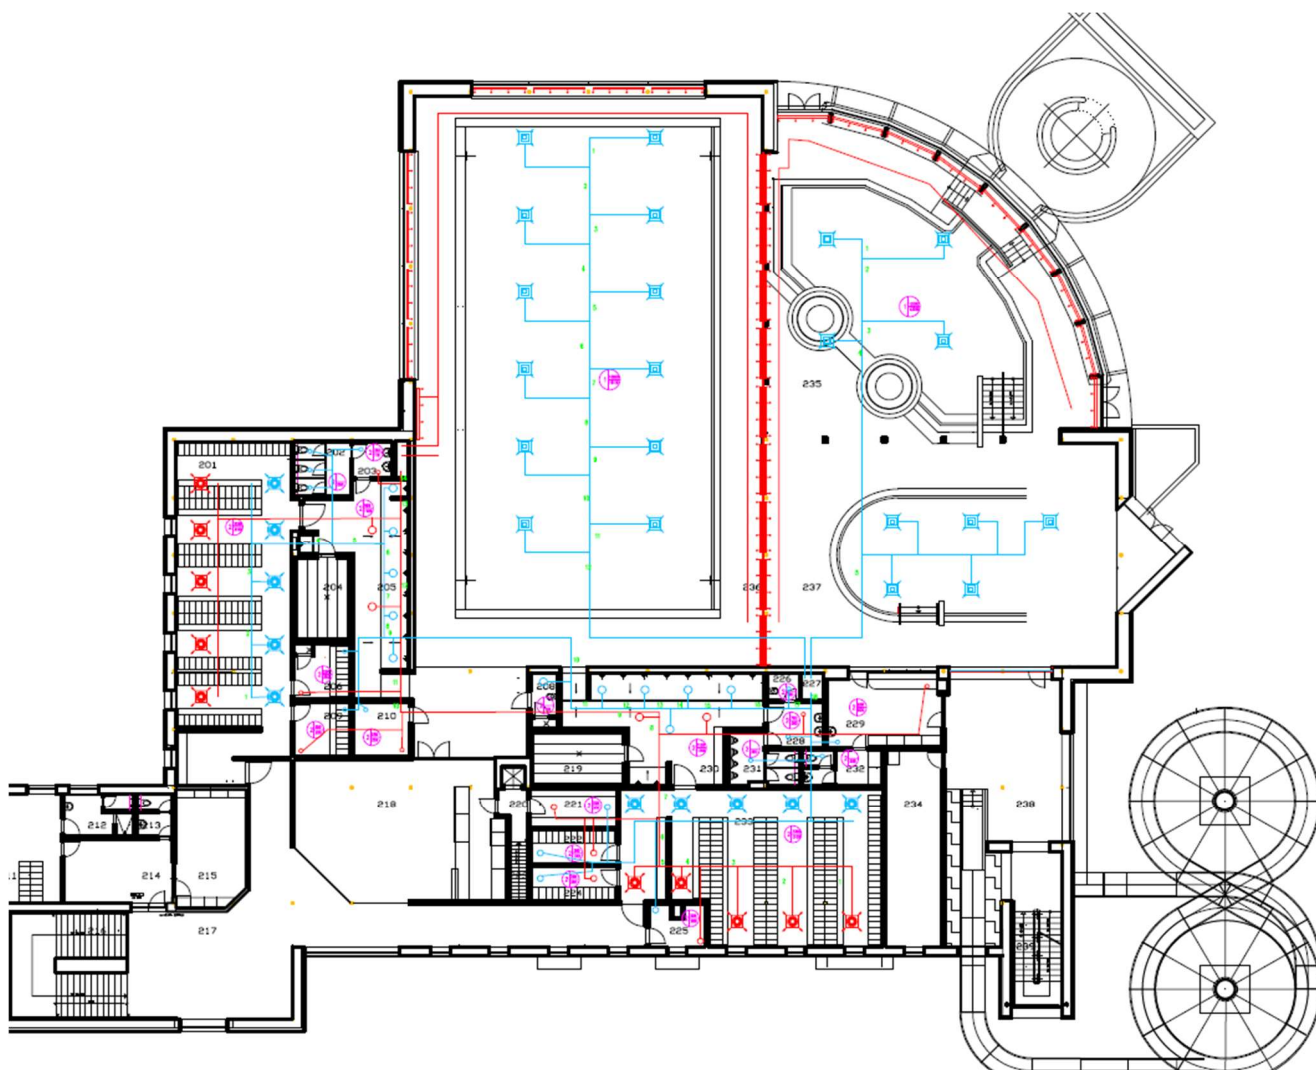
Návrh tanierového ventilu podľa prietoku vzduchu
